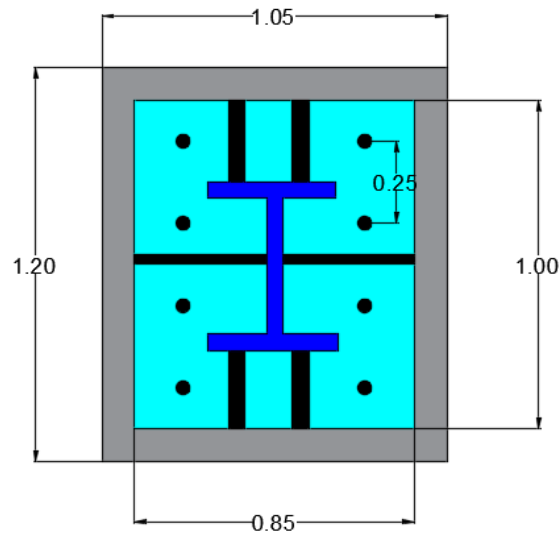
37. Detalle de placa base y pernos de anclaje
